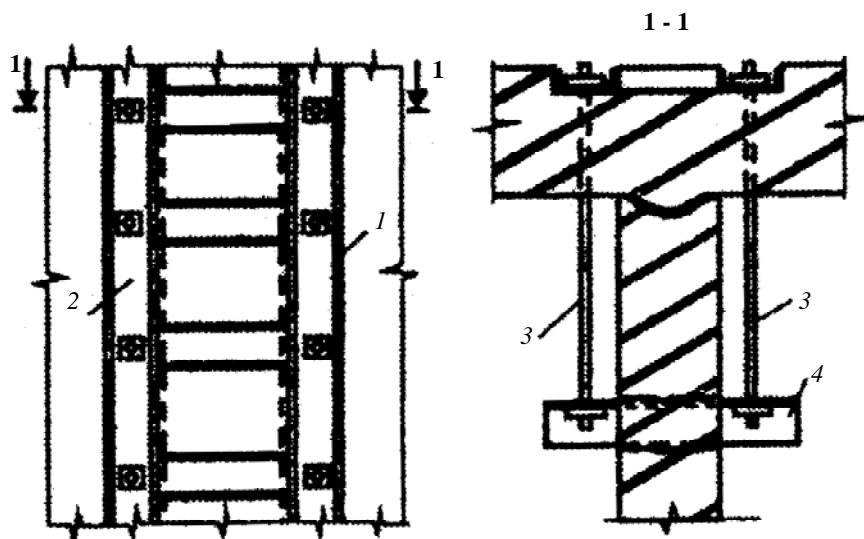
Усиление оторванной поперечной стены стяжными болтами:
